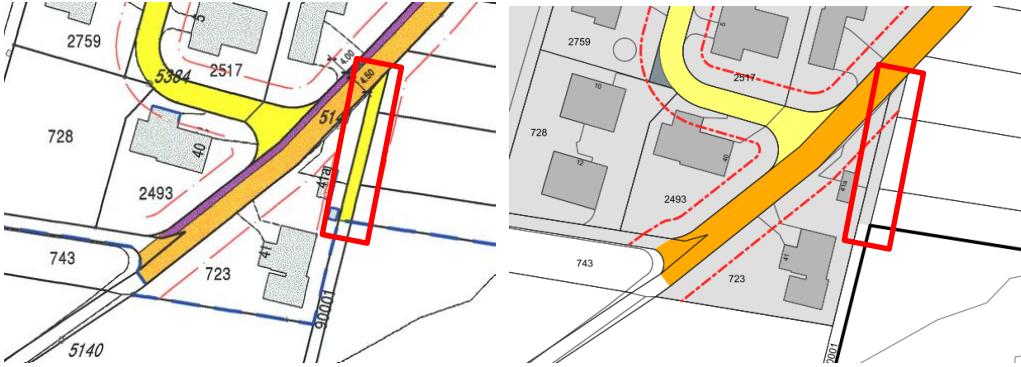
Links alter Erschliessungsplan, rechts revidierter Erschliessungsplan (Stand 1. Auflage)
